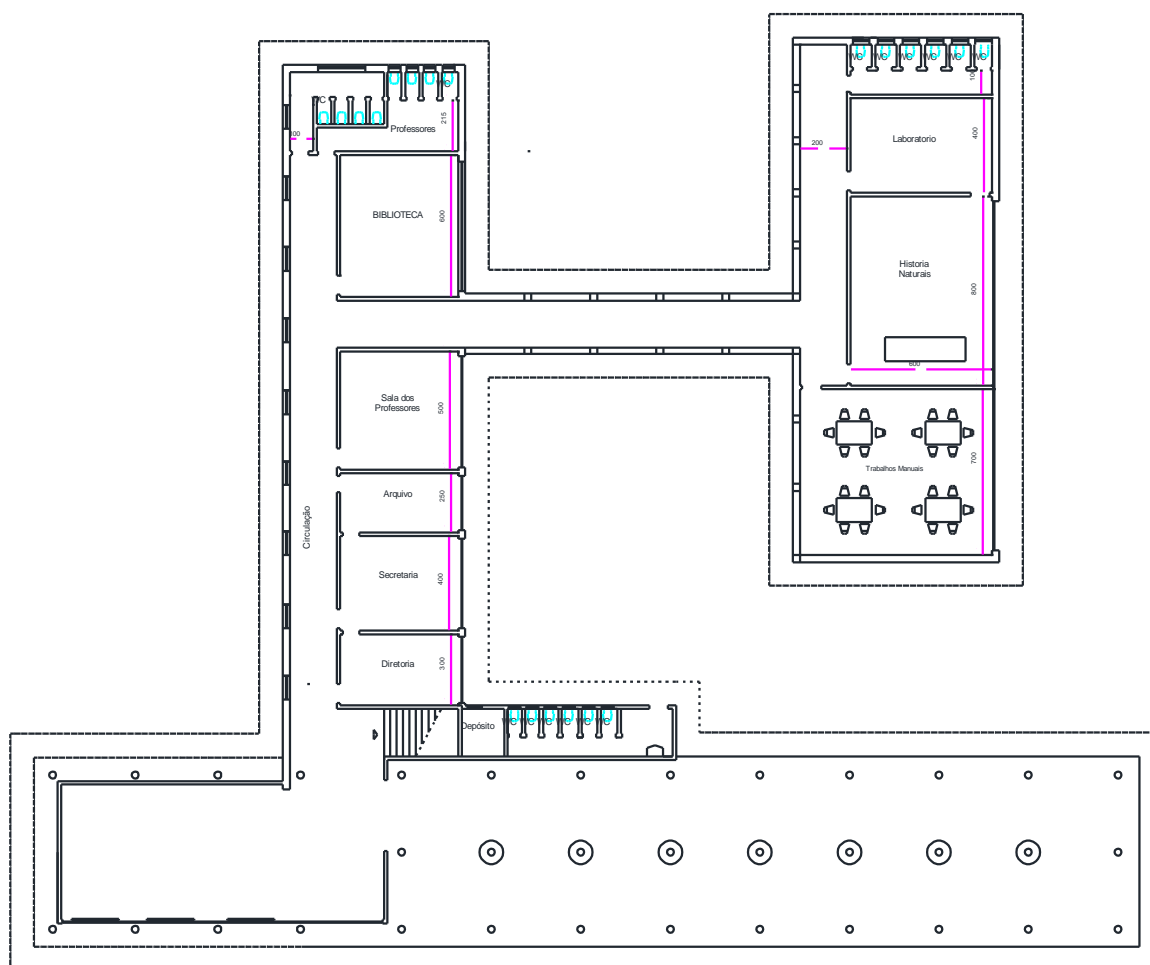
Planta Ginásio Estadual "Presidente Vargas" - 1º pav.
